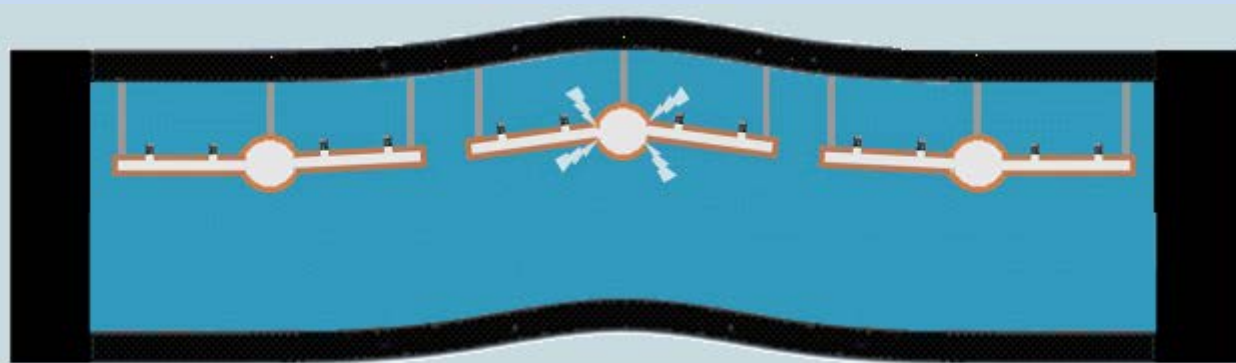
Продолжение начального разрушения герметичности стыков трубопроводов при резонансных колебаниях. Положение жёстко подвешенных распределительных  и питающих  трубопроводов при отклонении упругой конструкции из плит подвала вверх от положения устойчивого равновесия. -спринклер. -подвеска. -утечка воздуха.
